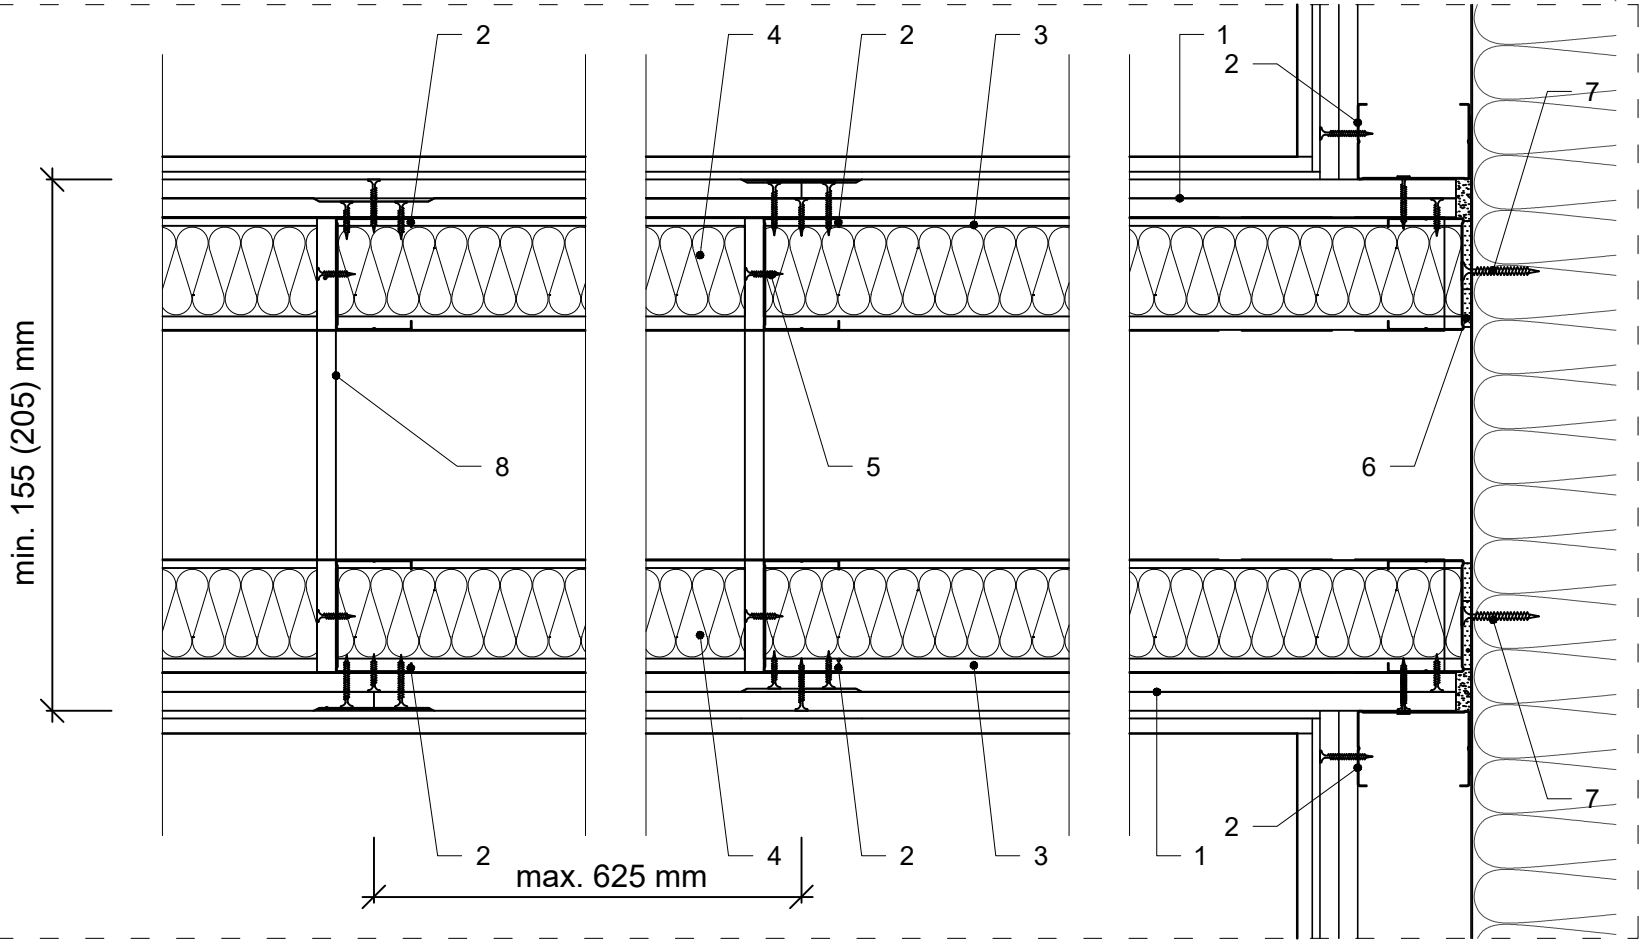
DETAIL NAPOJENIA SDK PRIEČKY NA OBVODOVÚ KONŠTRUKCIU
